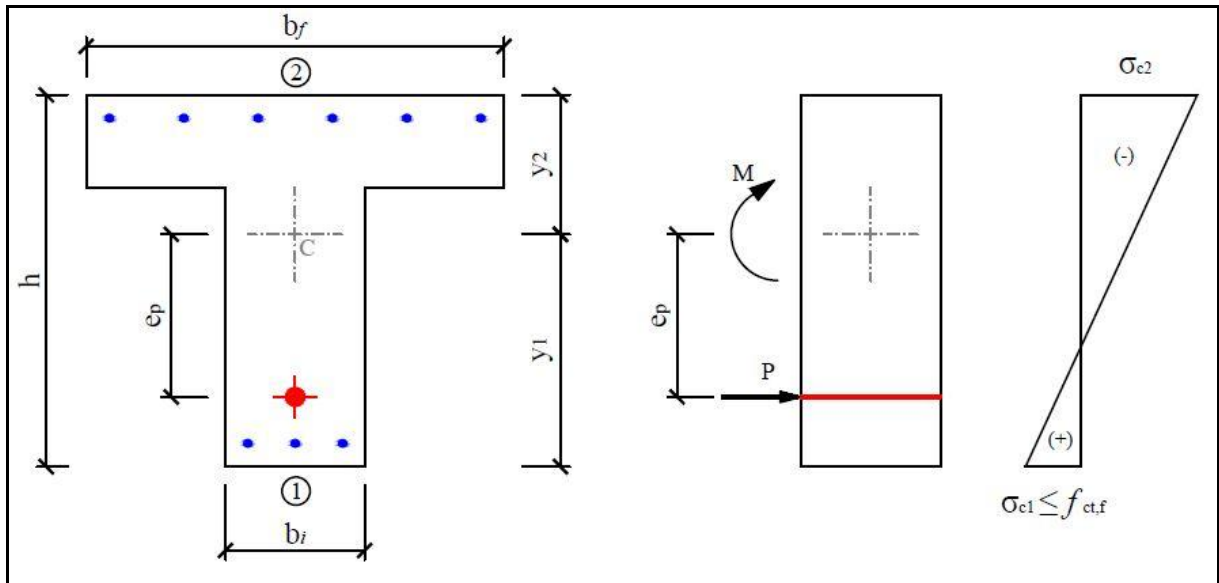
estado limite de formação de fissuras (adaptado de REAL, 2012).
